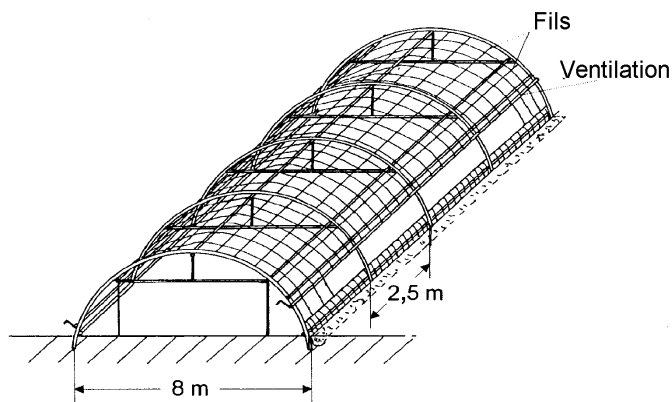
Tunnel de film plastique avec coupe transversale et ventilation latérale par enroulement
